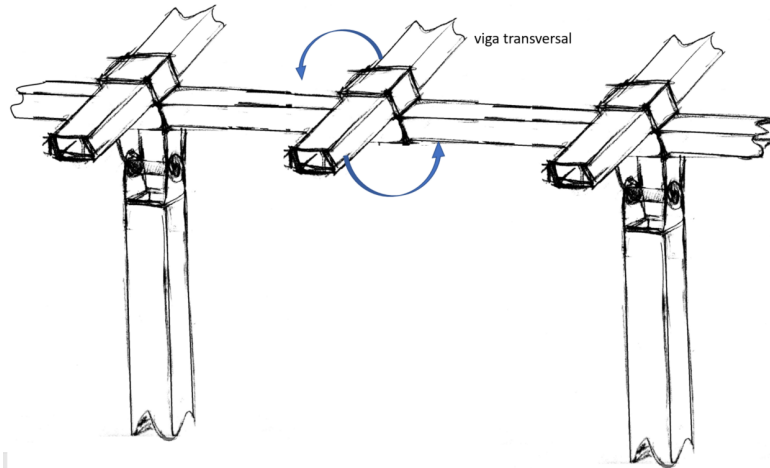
Terceira e final iteração com um sistema de dobradiça no encaixe pilar-viga: troca de posição das vigas longitudinal e transversais.
